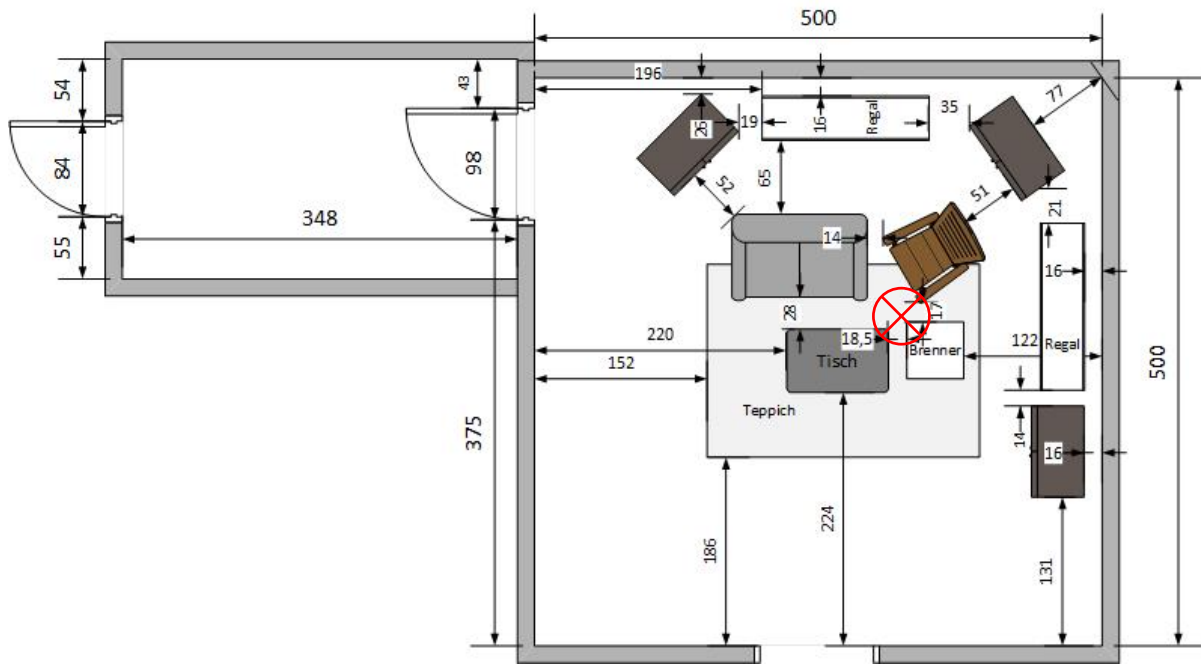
Grundriss Brandraum mit Möbeln
